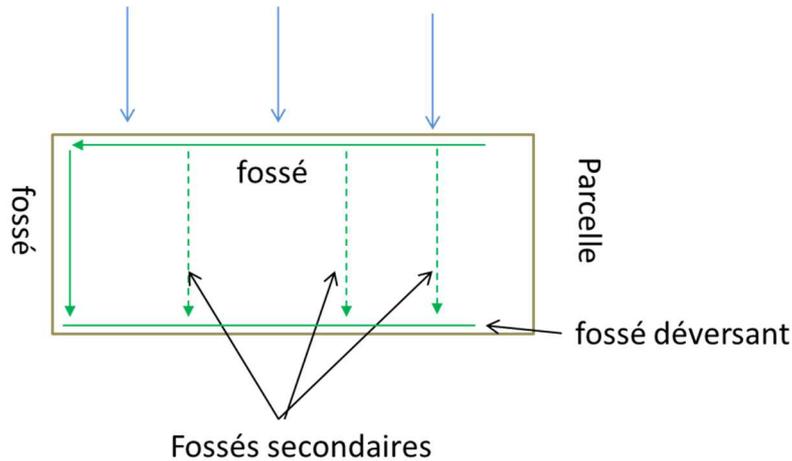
Dispositions constructives pour l'assainissement pluvial
